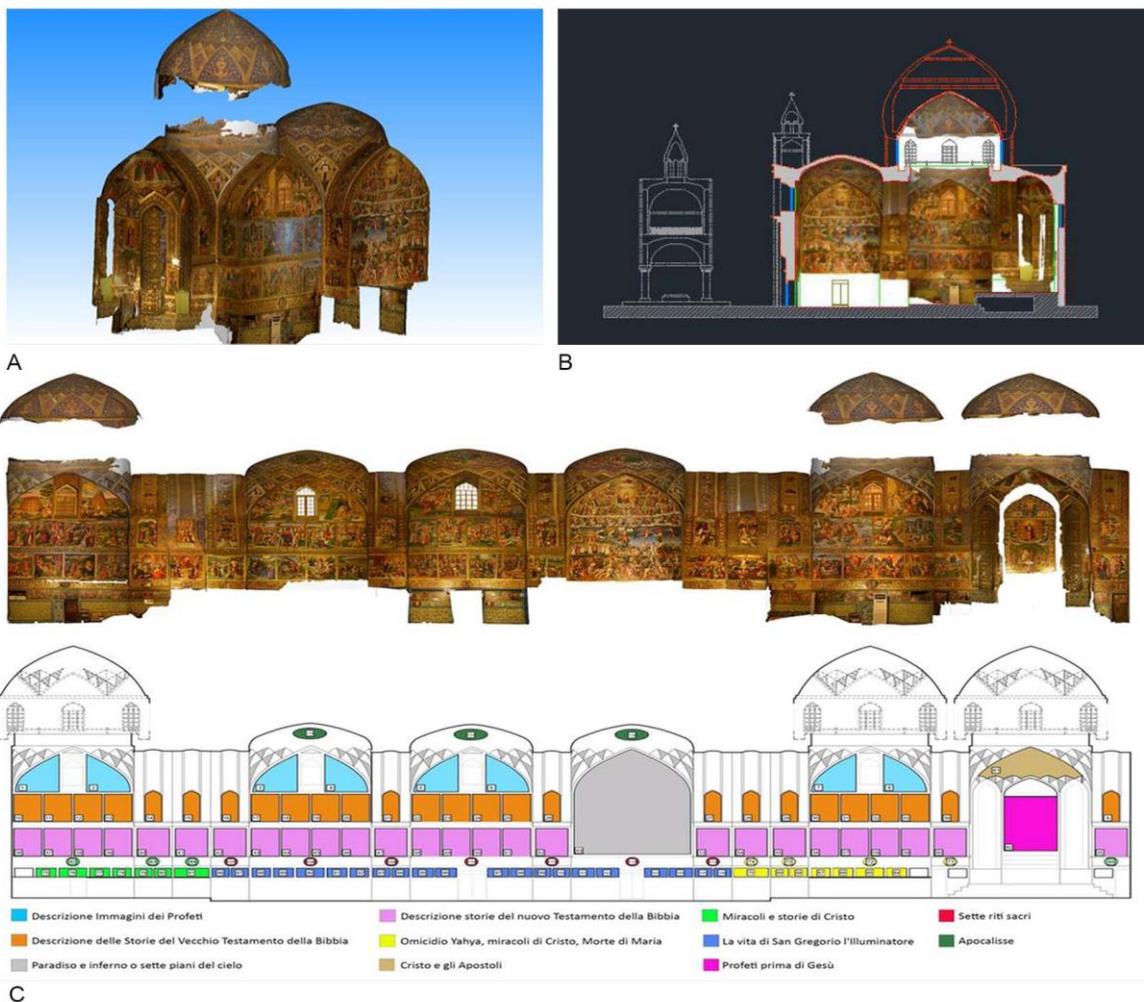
(A): Risultato finale dato dalla proiezione di tutte le ortofoto.
